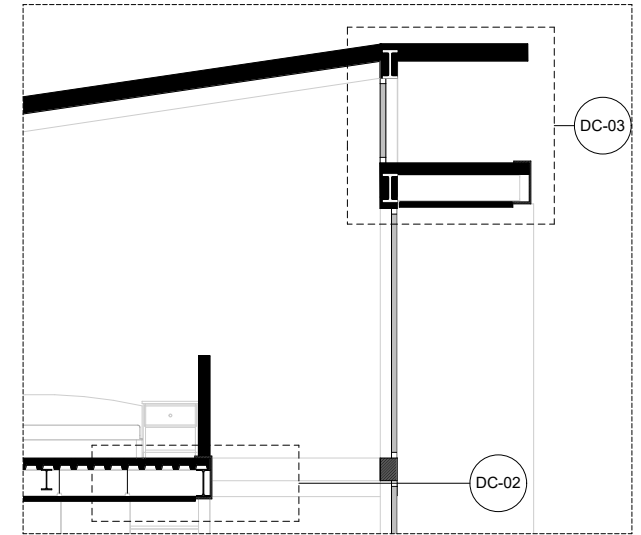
Sección constructiva 02 Fuente: Elaboración Propia
